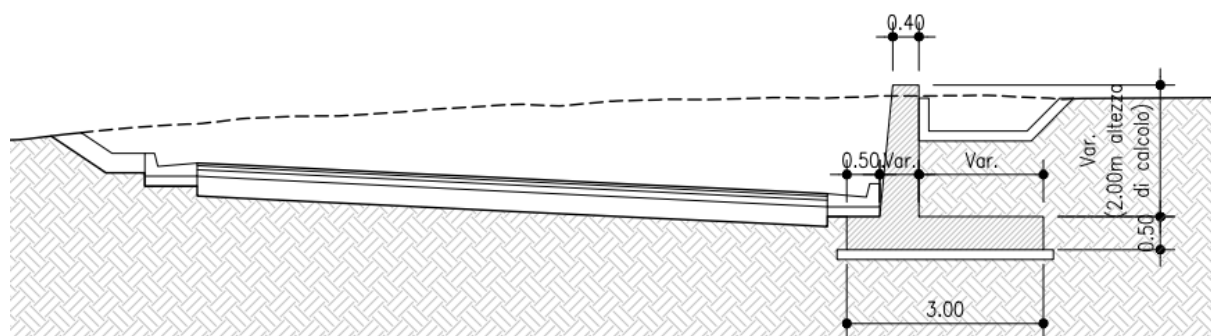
Muro ad L - Sezione trasversale - Conci 1 e 6
